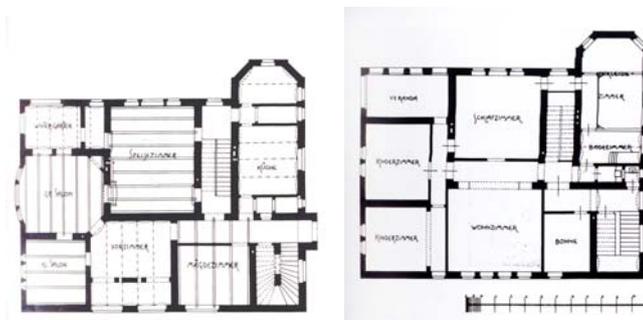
Haus Schopp. Grundriss von Parterre und 1. Stock. 1900.
